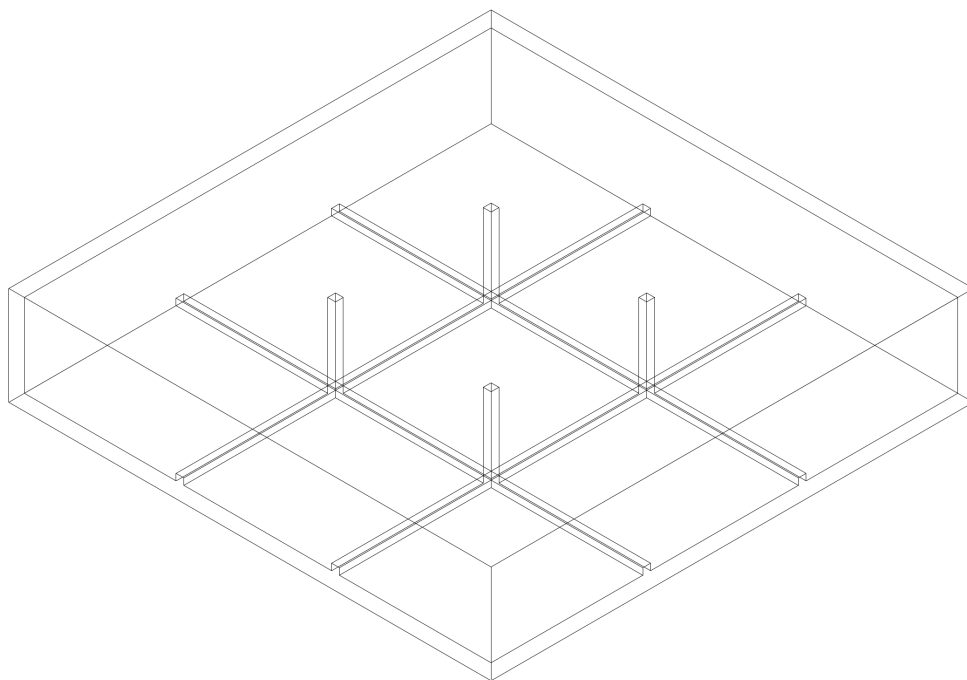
Vista dal basso dell'interno del serbatoio: struttura a piastre con travi ribassate e pilastri.
